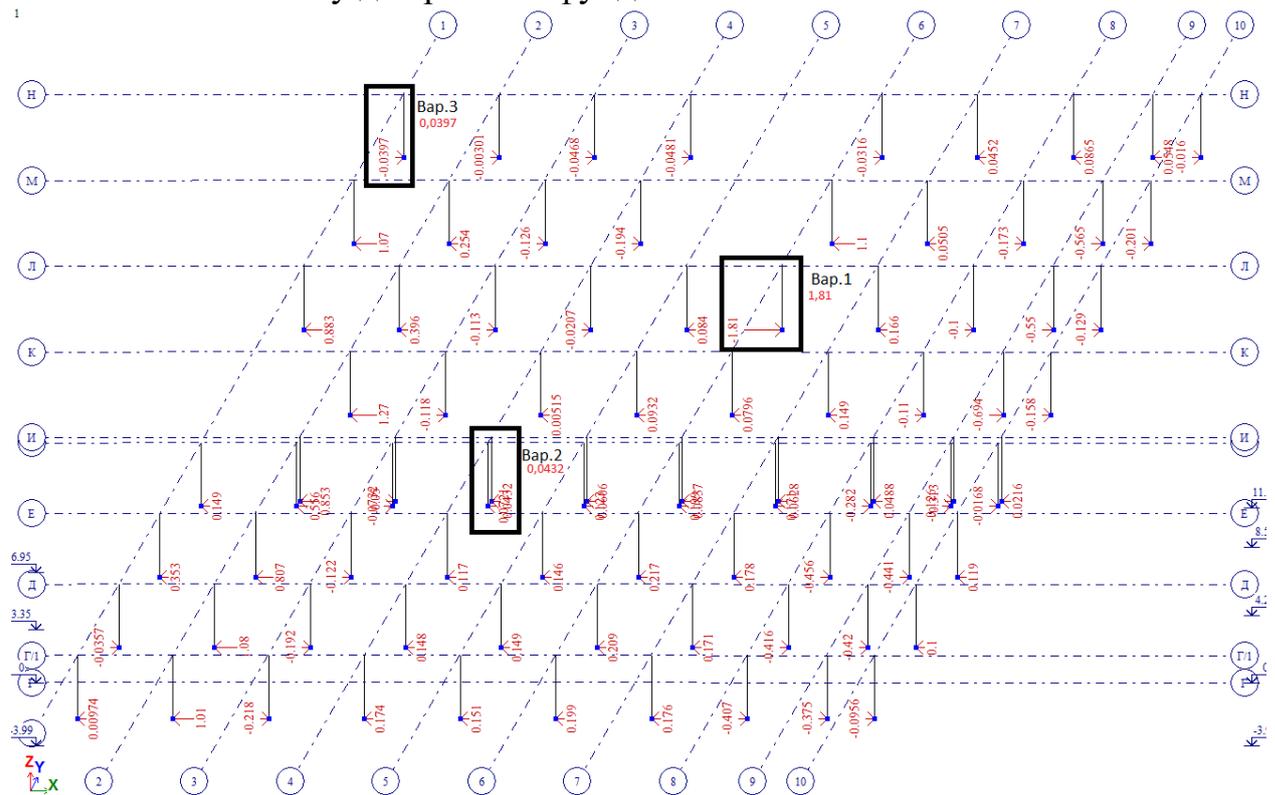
Сила  $Q_x$  для расчета фундаментов
